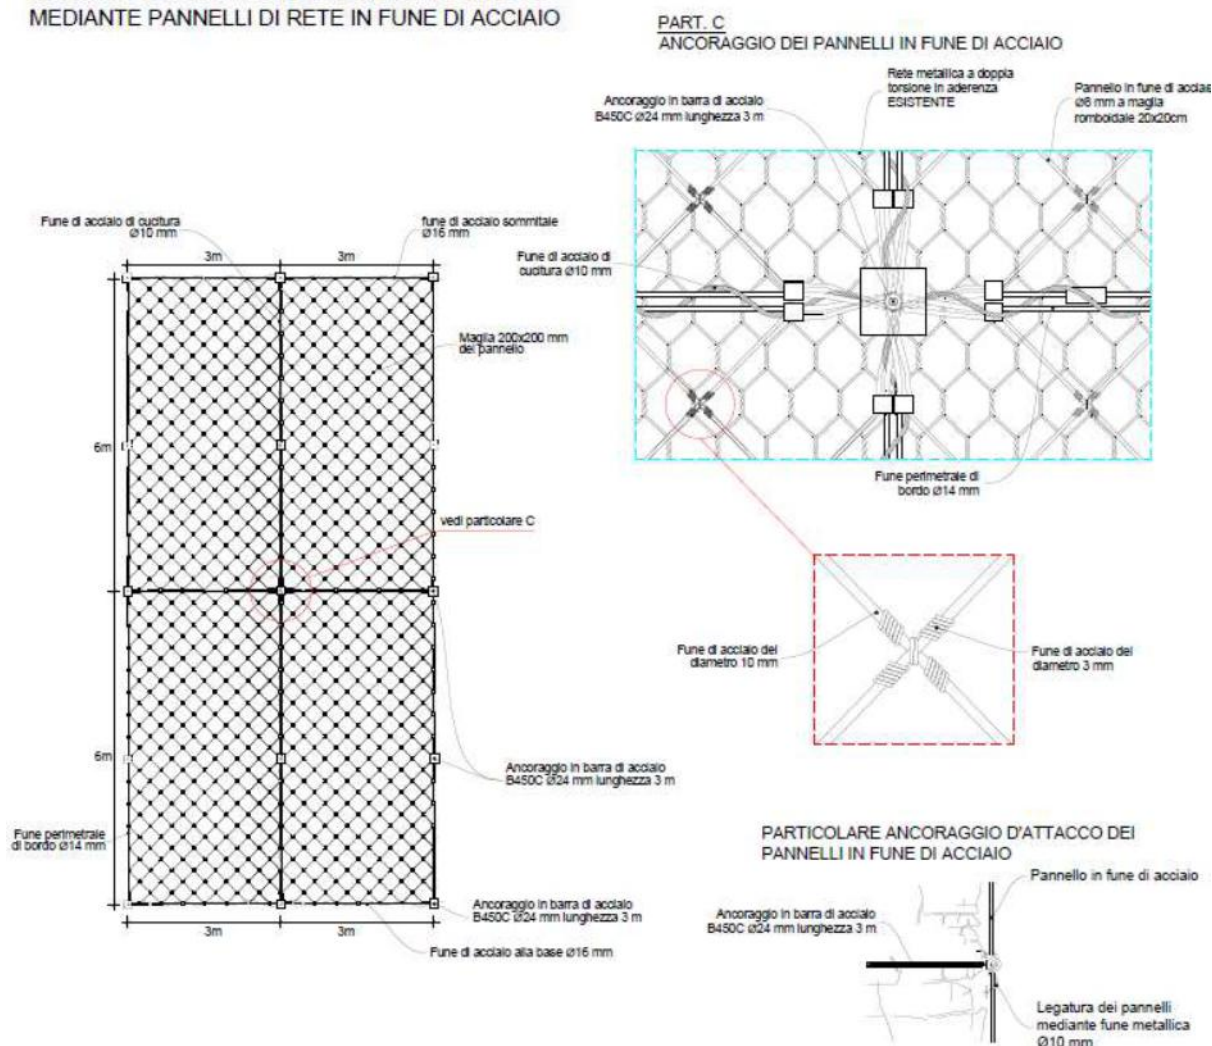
Dettaglio schema intervento di rafforzamento corticale – Settore C
